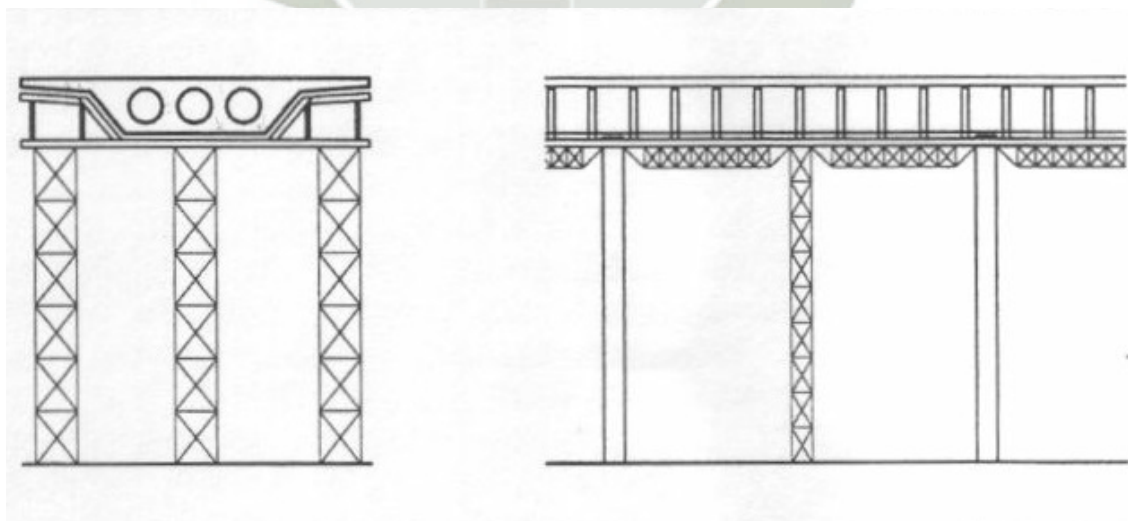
Cimbra tipo torres o vigas metálicas (Fuente: Ministerio de Fomento
